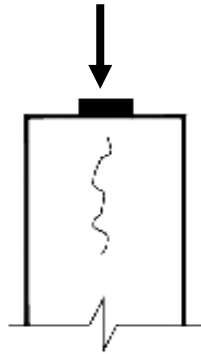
Fissuras devido cargas concentradas – insuficiência de armadura de fretagem. (IPR Publicação, 709 – 2004)
